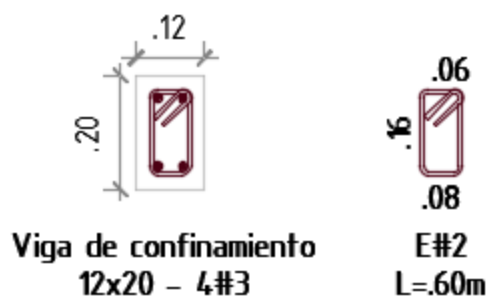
Detalle de refuerzo de vigas de confinamiento a nivel de cubierta
